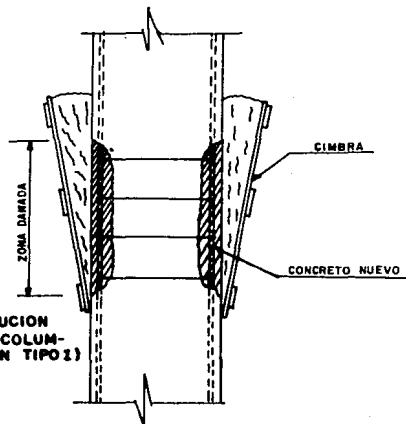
SUSTITUCION DE CONCRETO EN COLUMNAS (REPARACION TIPO I)
